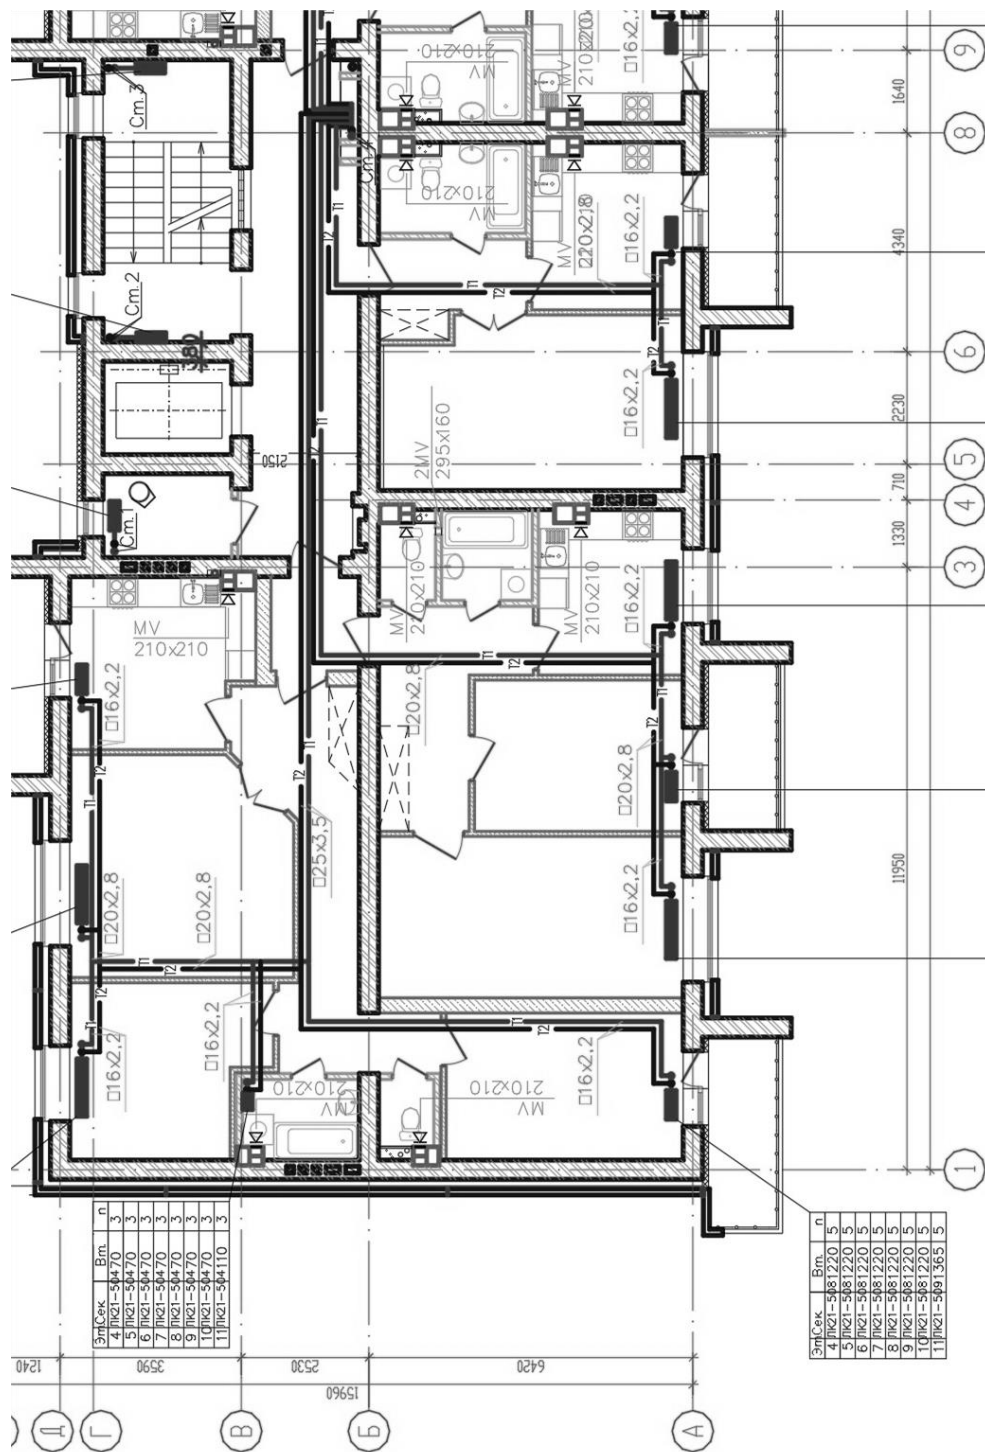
План 11 этажа в осях 1–12 с элементами системы отопления
